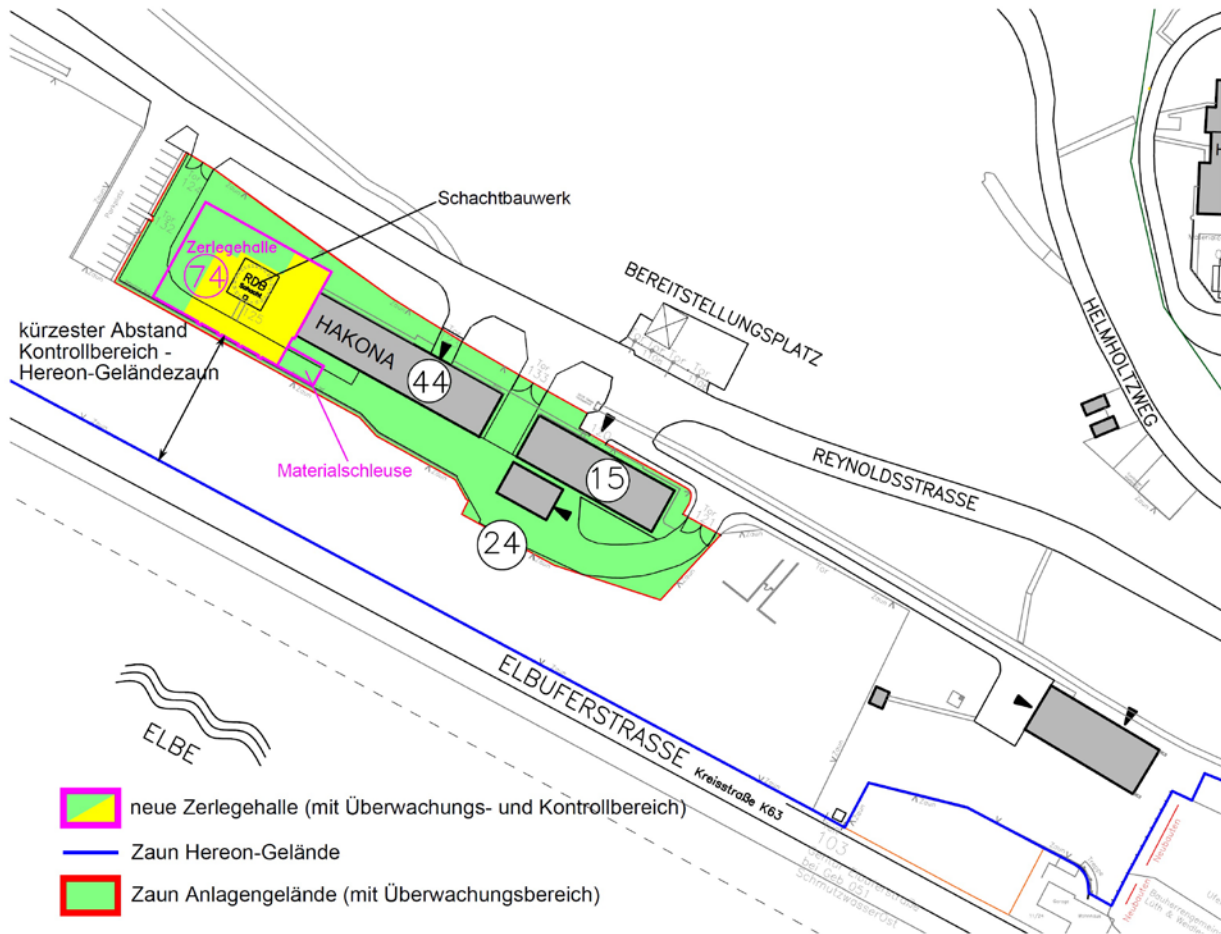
Lageplan Zerleghalle (mit HAKONA/BSH), kürzester Abstand Kontrollbereich - Zaun 34 m
